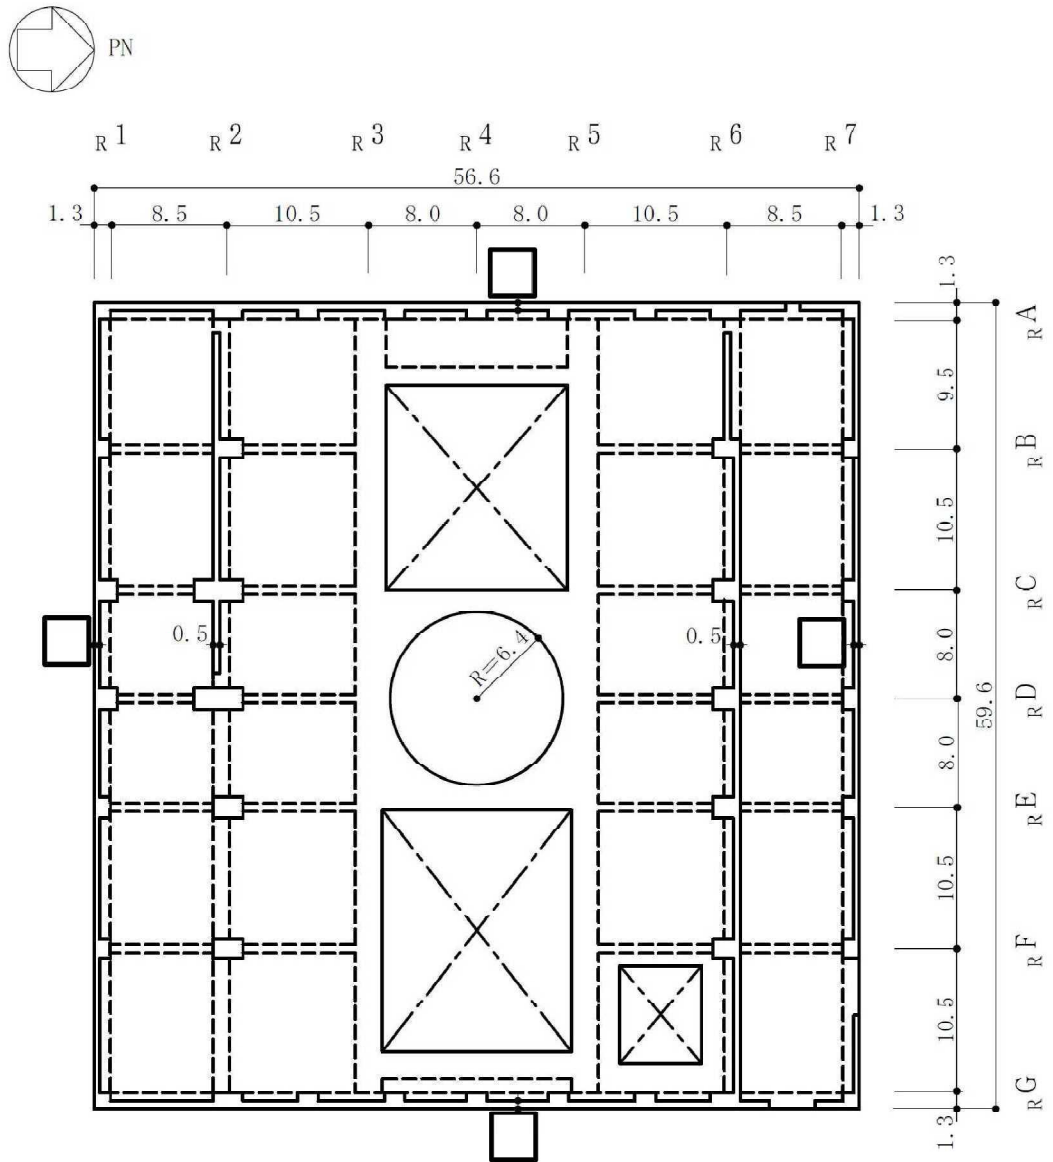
原子炉建屋の概略平面図 (2F, T.M.S.L. 18.1m) (5/9)
